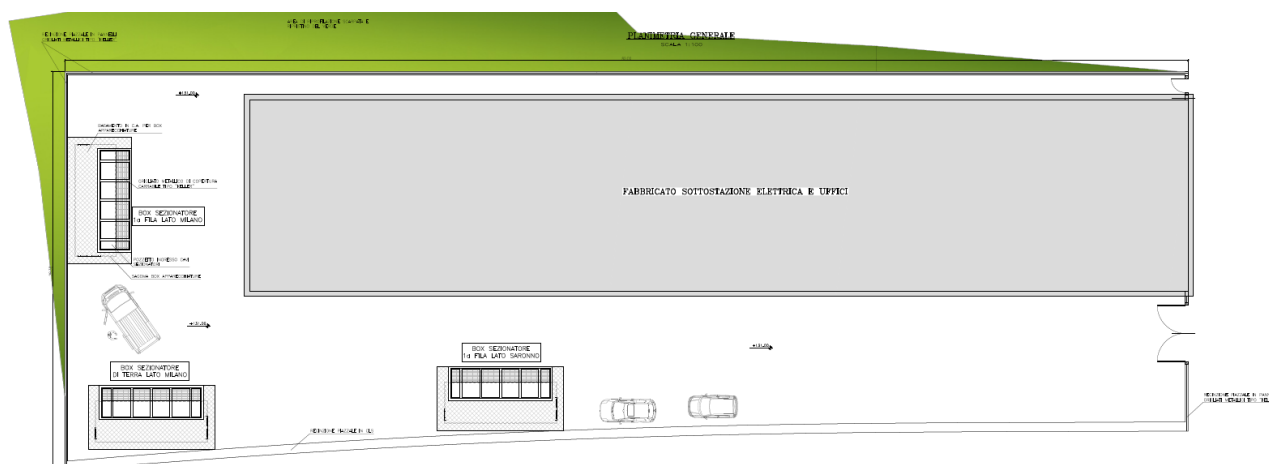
Planimetria generale nuova sottostazione elettrica e relativo piazzale di pertinenza.
